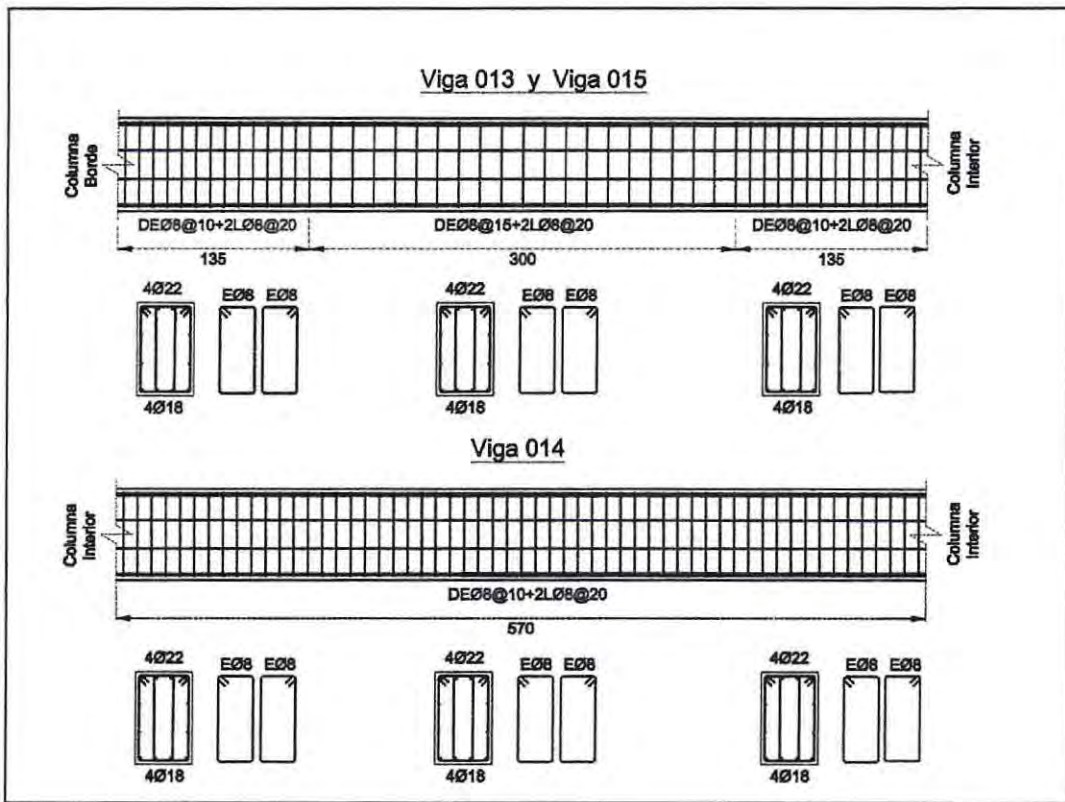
Distribución armadura de corte en vigas Eje 1, estructura mixta.
